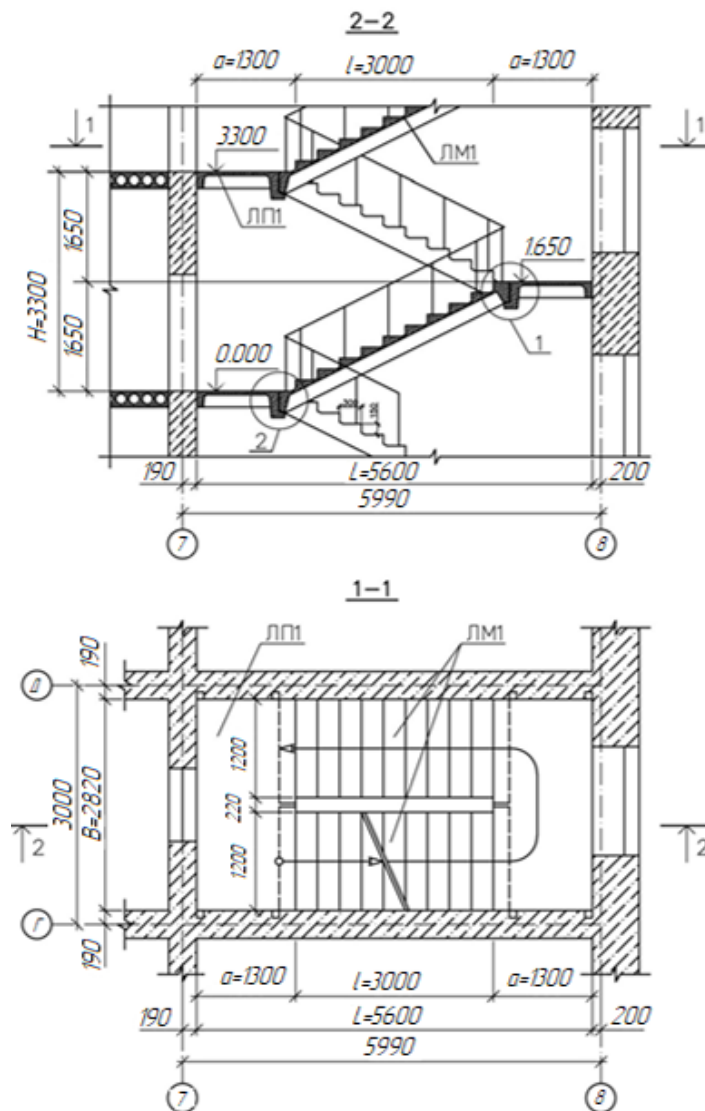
Поздовжній розріз сходів та фрагмент плану сходової клітки
